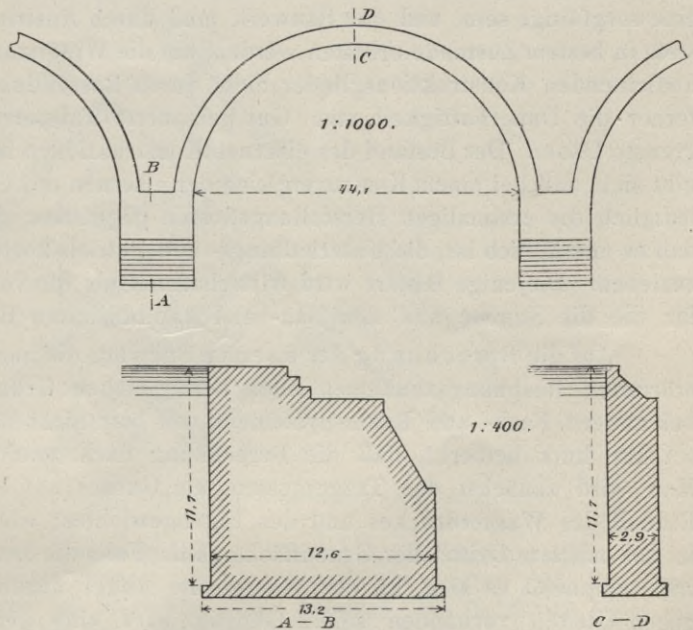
u. 198. Lageplan und lotrechte Schnitte durch die Meer Allum-Talsperre.
